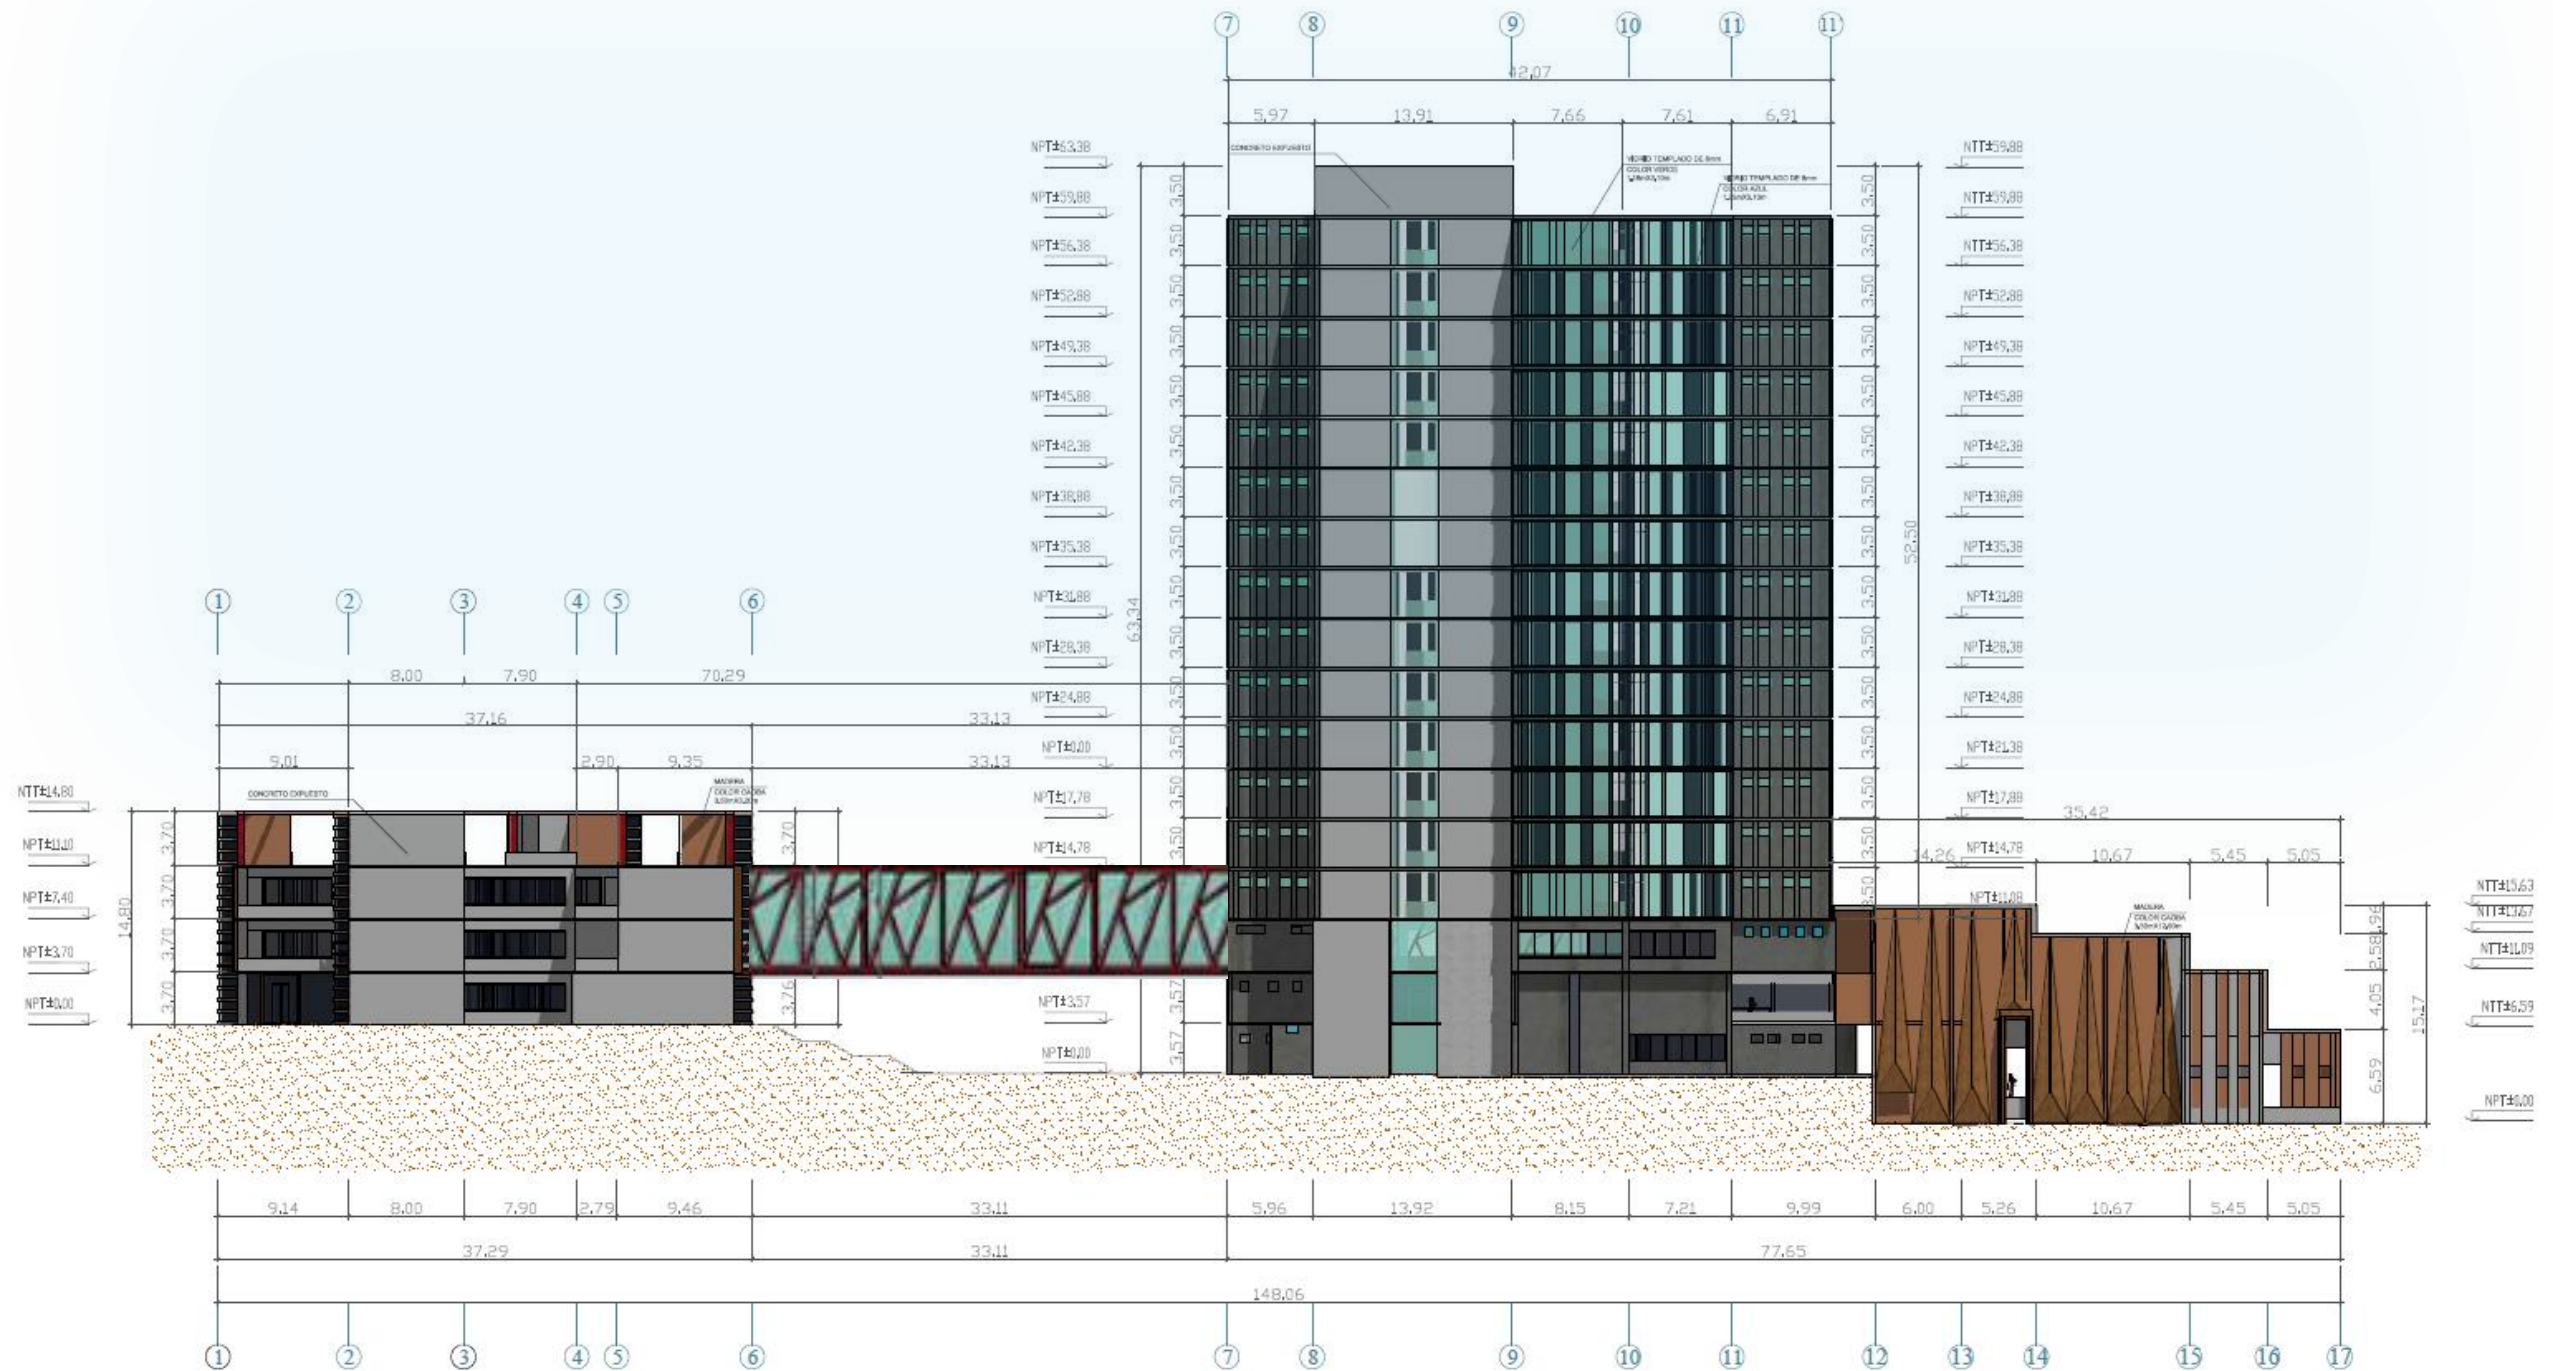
Elevación Posterior del Proyecto, Elaboración Propia.
